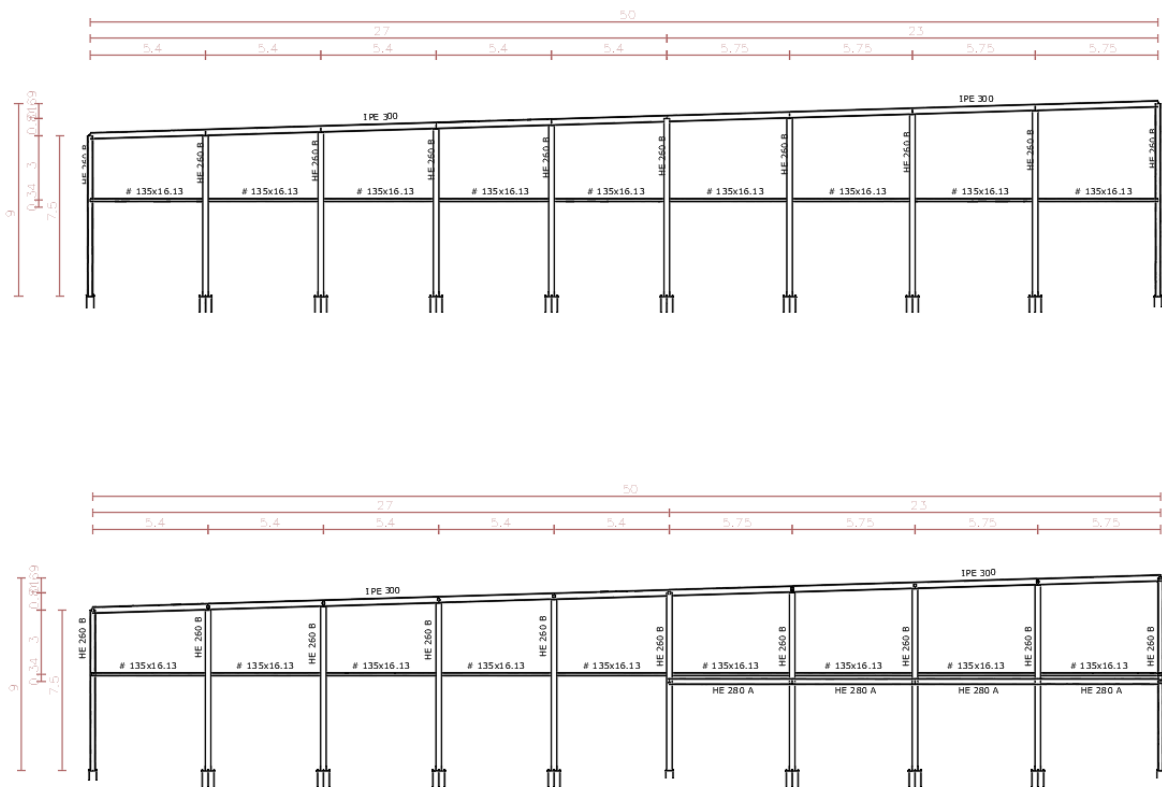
Pórticos de fachada, sin forjado y con forjado, respectivamente.
